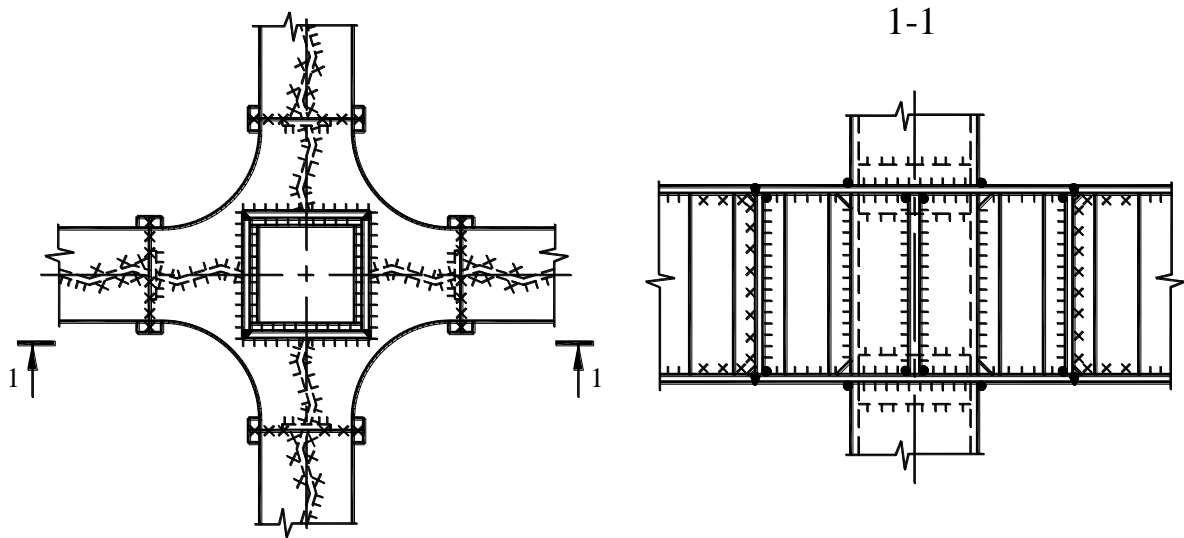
Сварной рамный узел каркаса с колоннами
